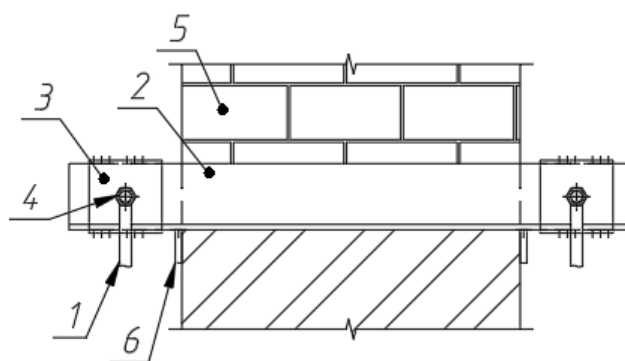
Конструкция для временного усиления кирпичных стен с проемами при демонтированных перекрытиях (изображен вид Б на рис. 3):
